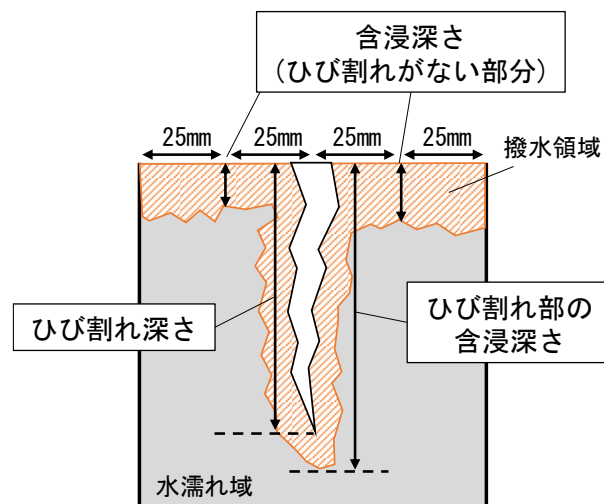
ひび割れを考慮した含浸深さの測定位置(ひびあり試験体)
